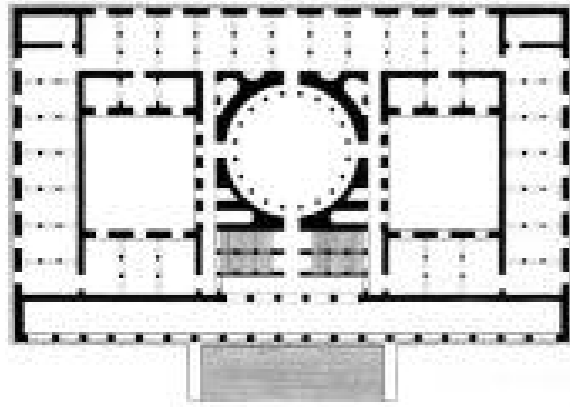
(links): Karl Friedrich Schinkel, Altes Museum, Berlin, Deutschland, 1822–1828. Grundriss (Maßstab 1:1500)
